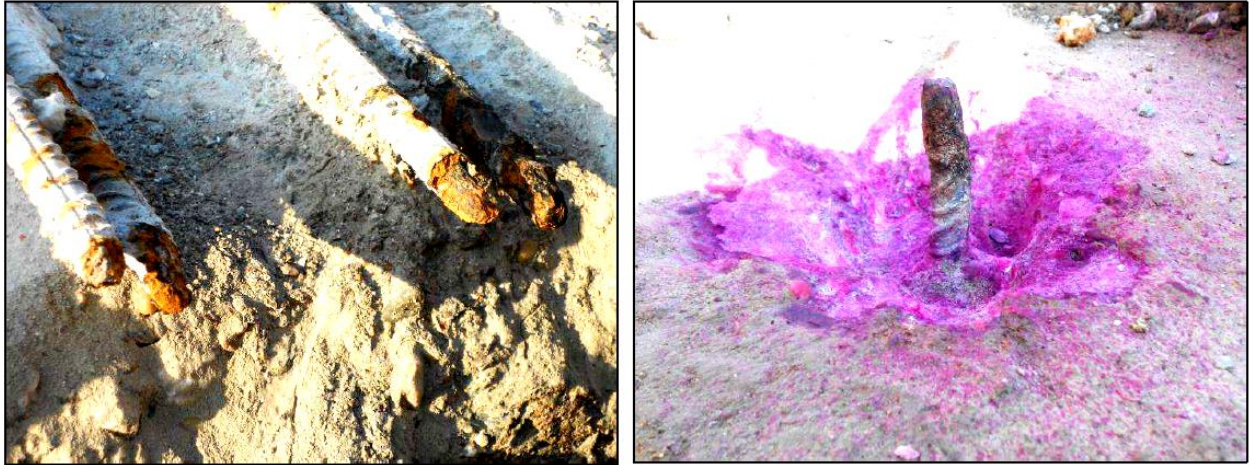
Muestras acero. Canal Calzas Anchas, Utrera. (Fuente Vorsevi).
